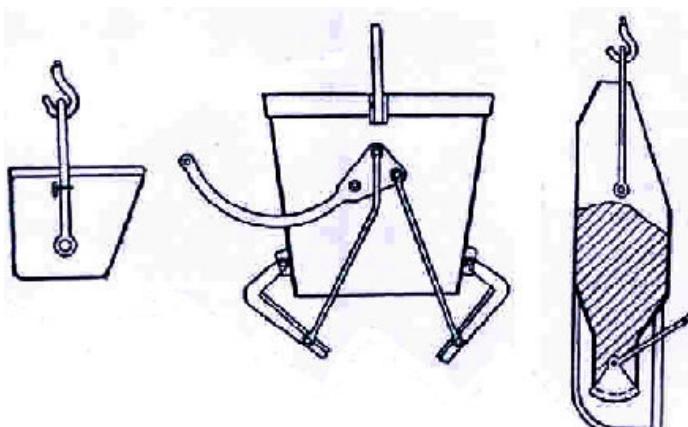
Бадді для бетонних сумішей – перекидна, неперекидна з двостулковим затвором, ківш-баддя
